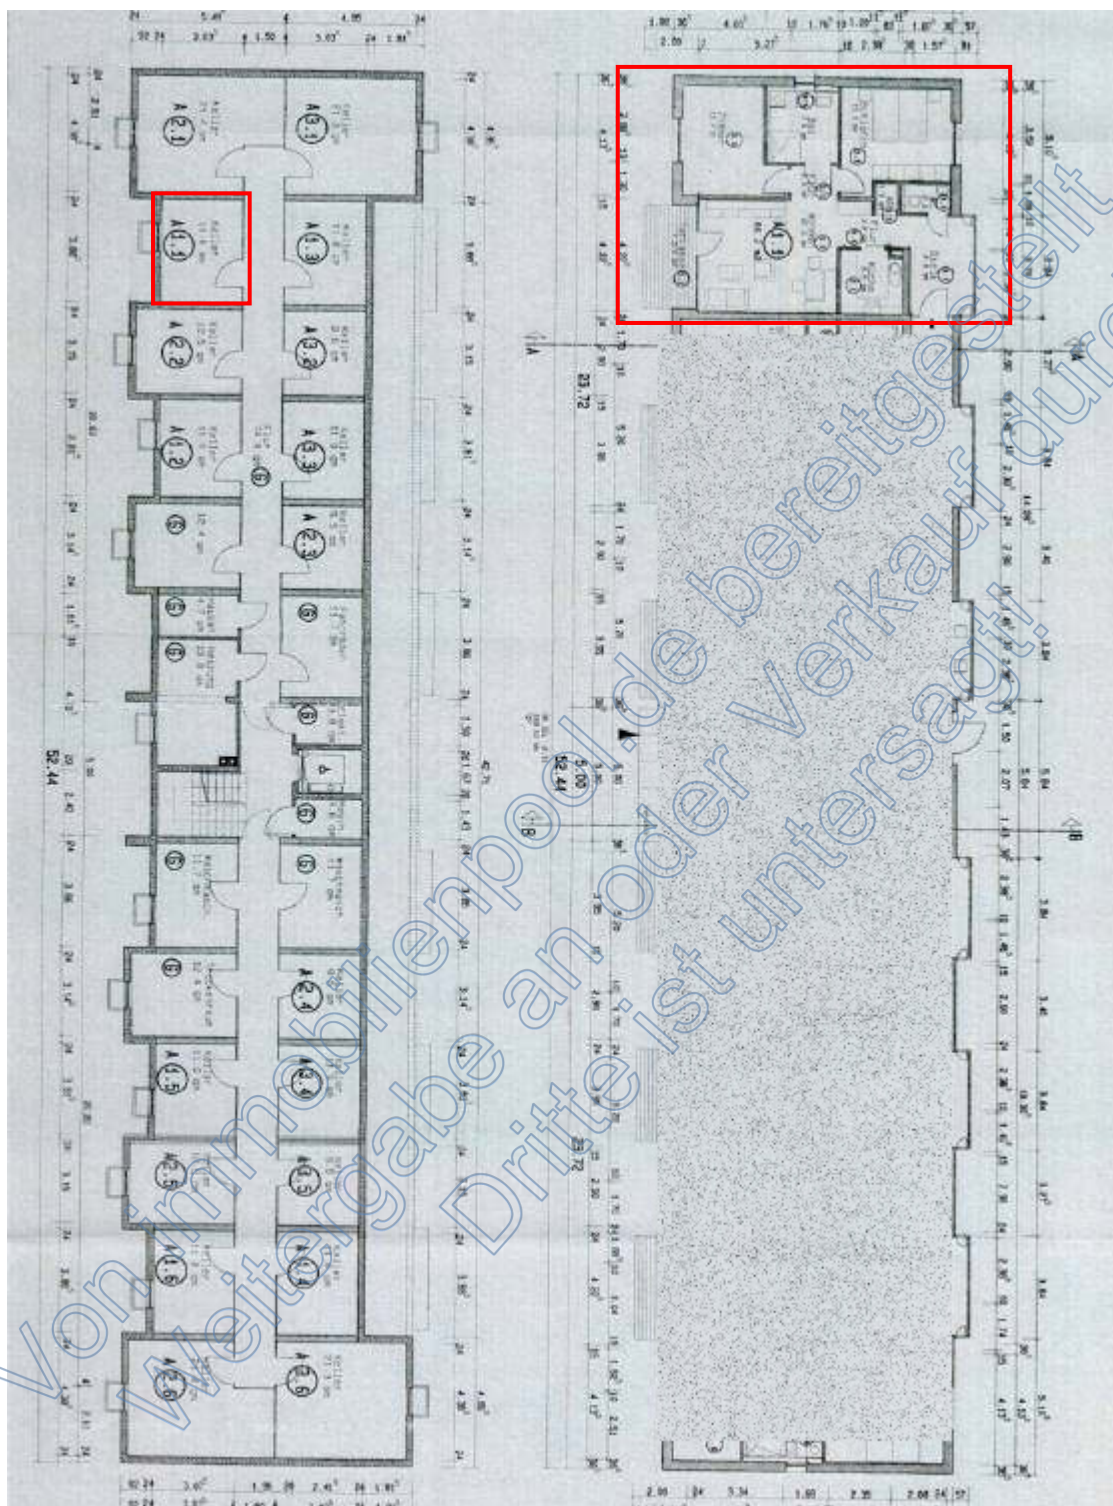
Grundriss UG und EG (ohne Maßstab); Details: Wohnung und Kellerraum Nr. 1.1.;
